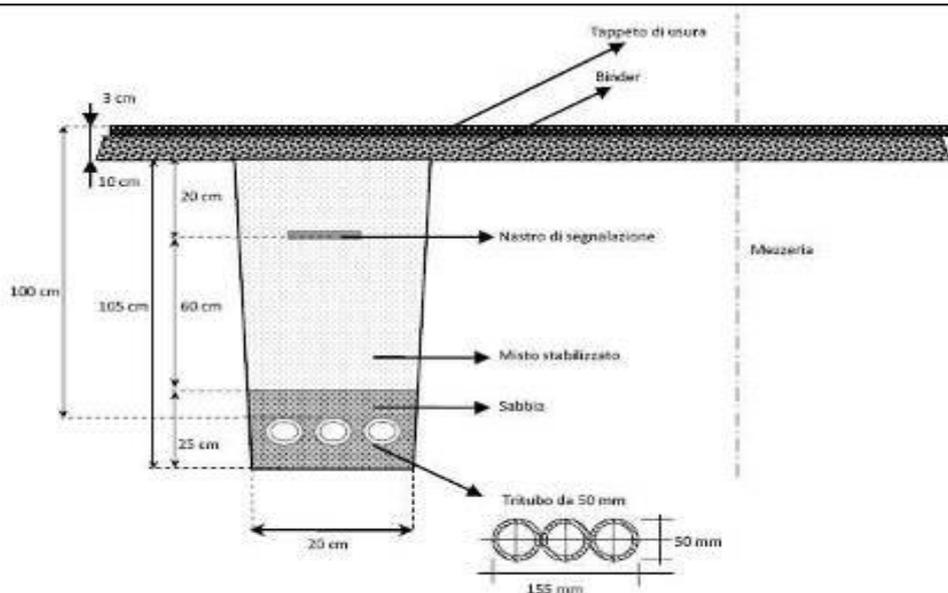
Sezione tipo scavo in trincea su sede stradale.
